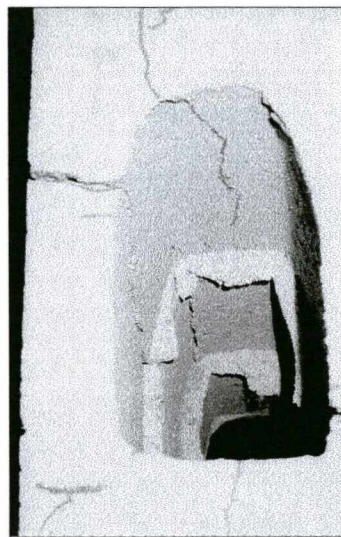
Foto das fissuras e da junta interna
